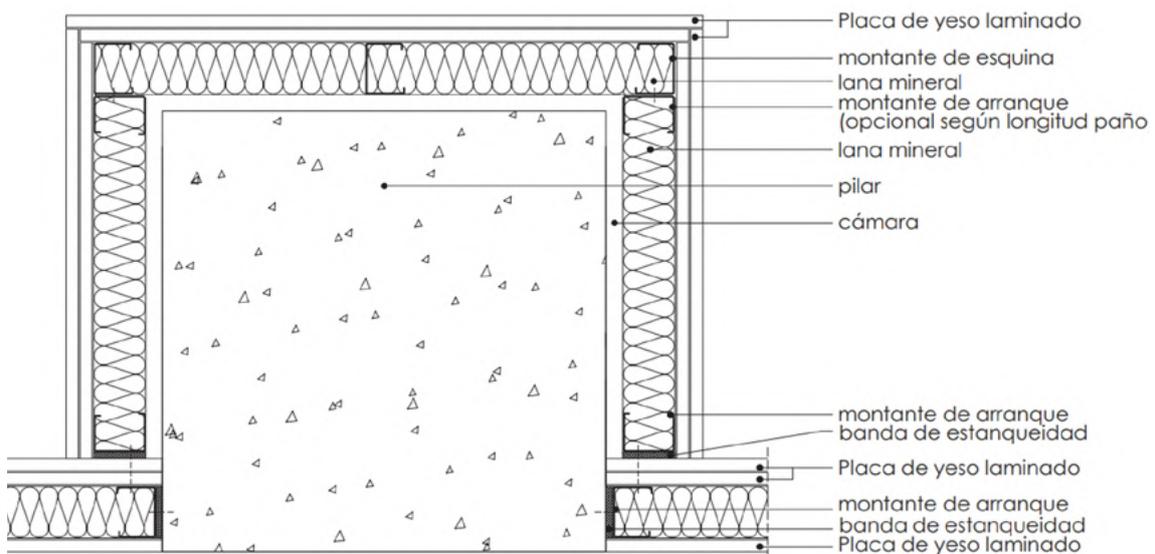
Detalle de instalación de un trasdosado alrededor de un pilar.
